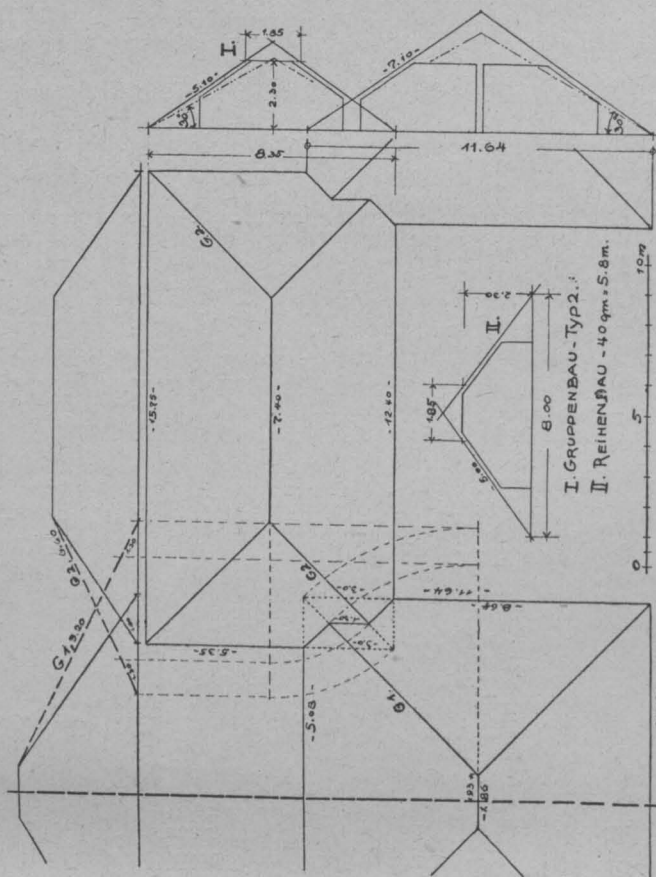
Dachausmittlung des Types 2 nach dem Grundriß Abb. 9, Fig. 2.
